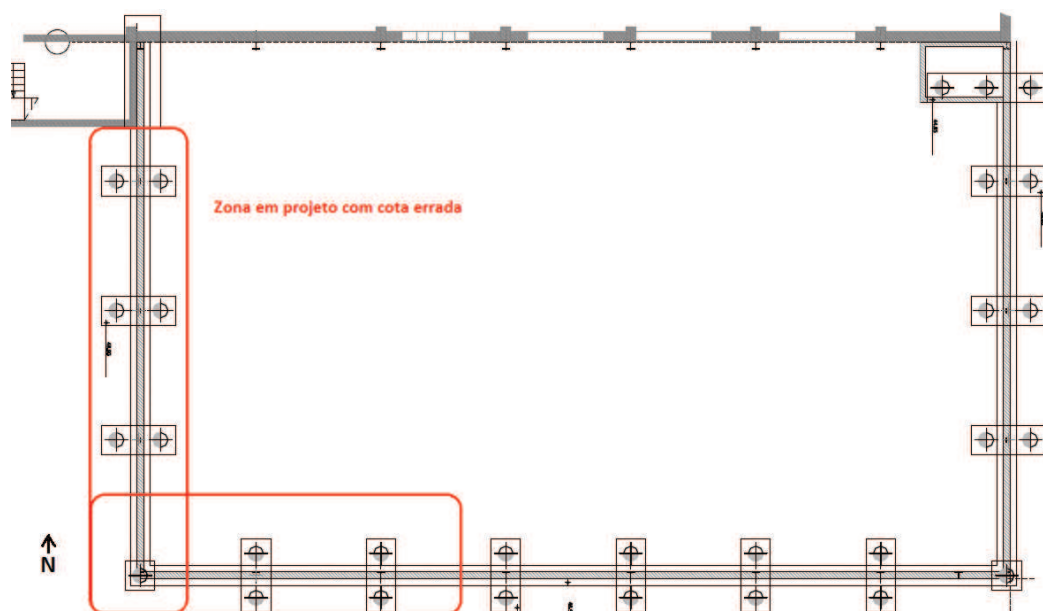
Planta de fundações com delimitação da zona com cota errada.
